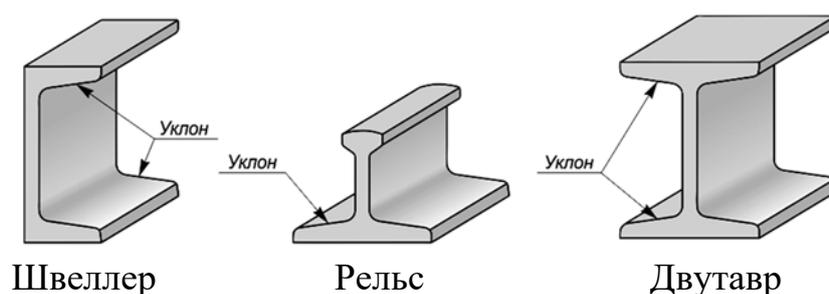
Стальной фасонный прокат для металлоконструкций
